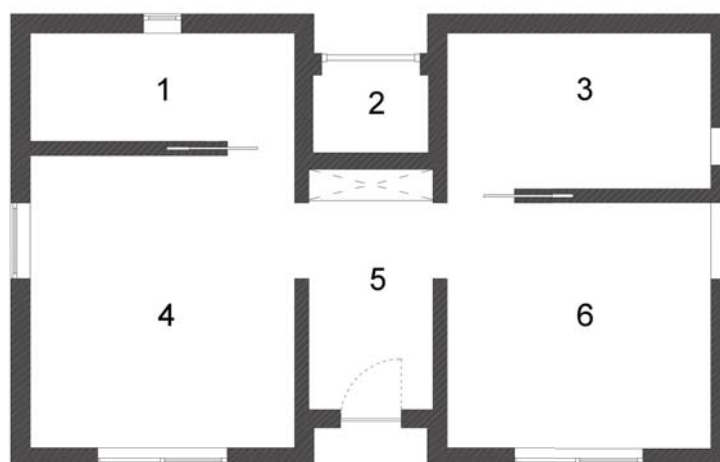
Planta da tipologia T1 (escala: 1:100)
